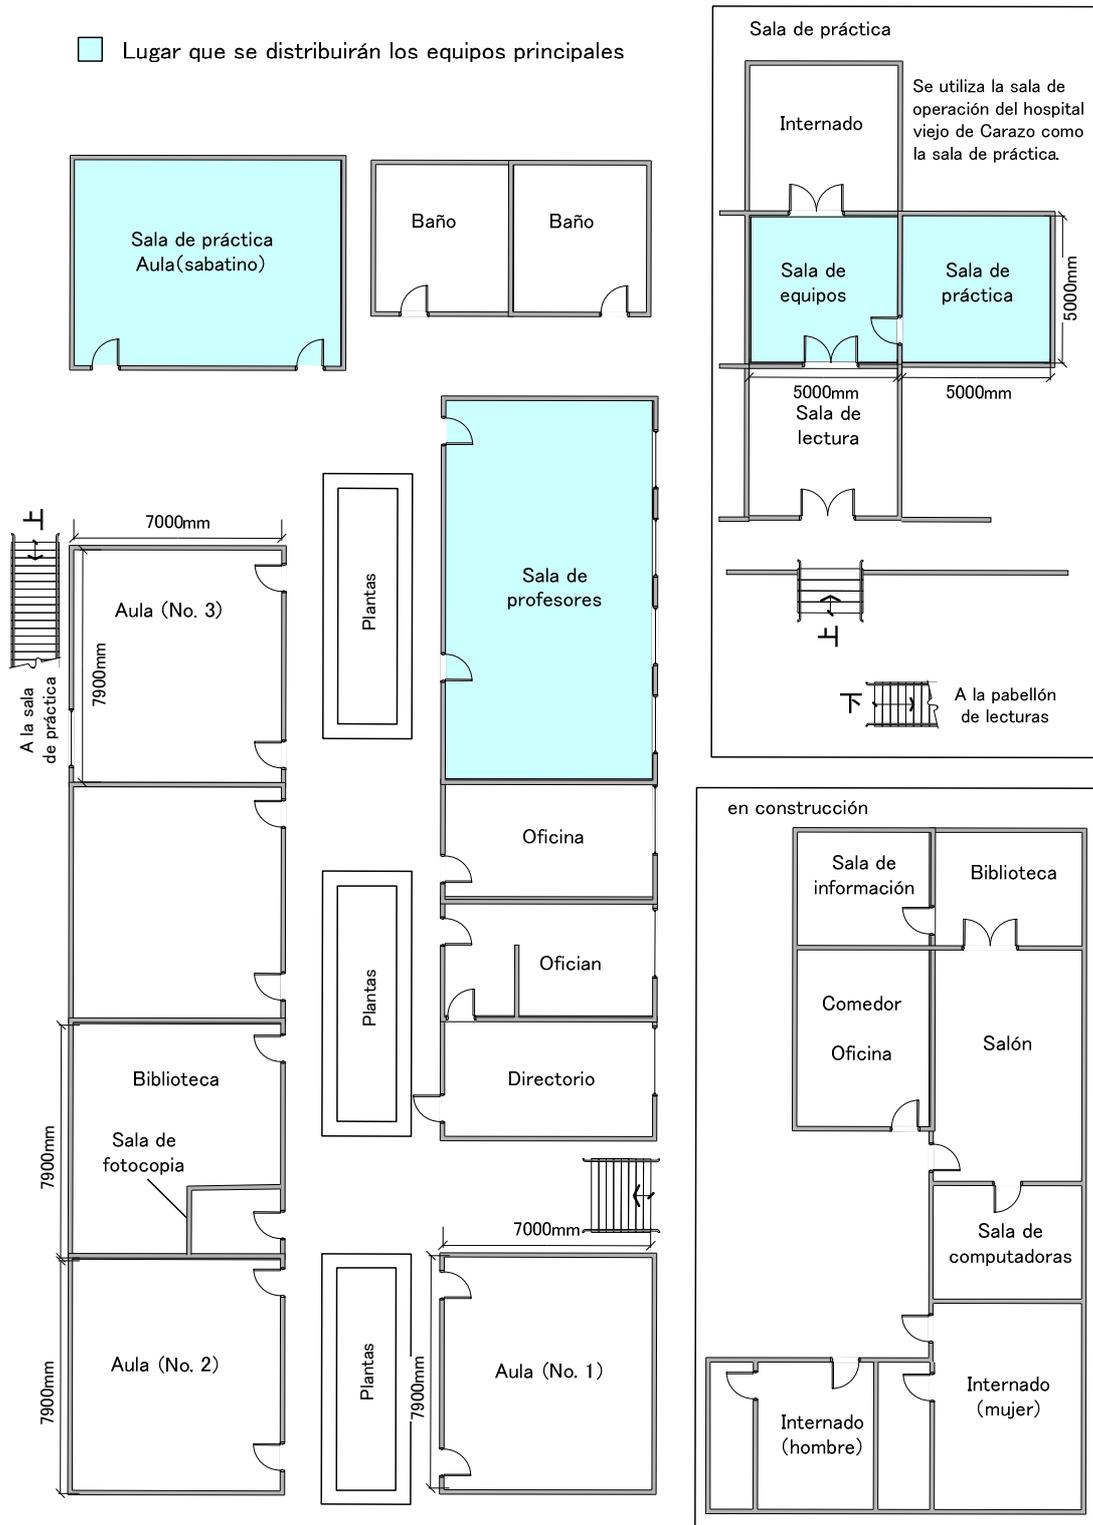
Plano de la Escuela de Enfermería de Jinotepe
